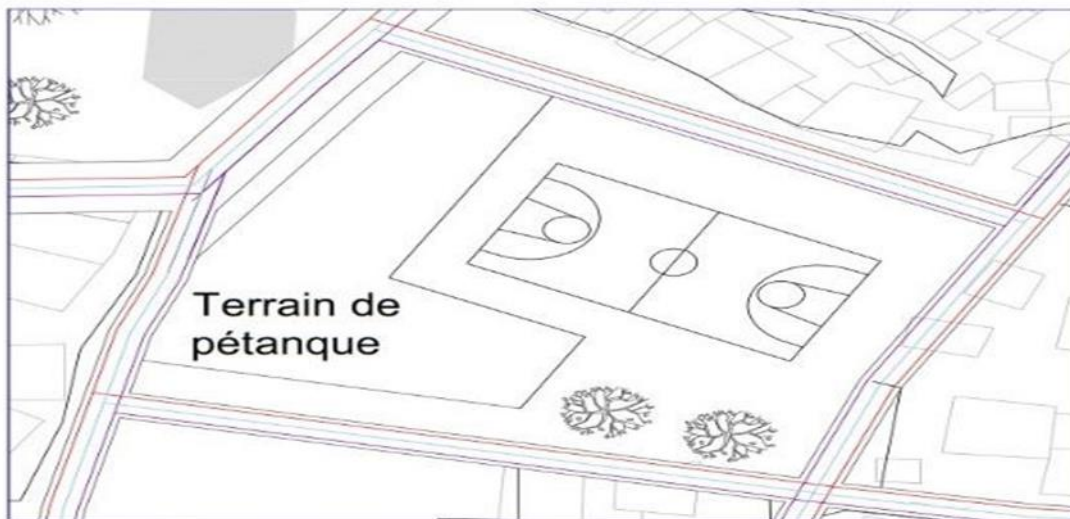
Plan illustratif du Terrain de Sport de 1779 m²
